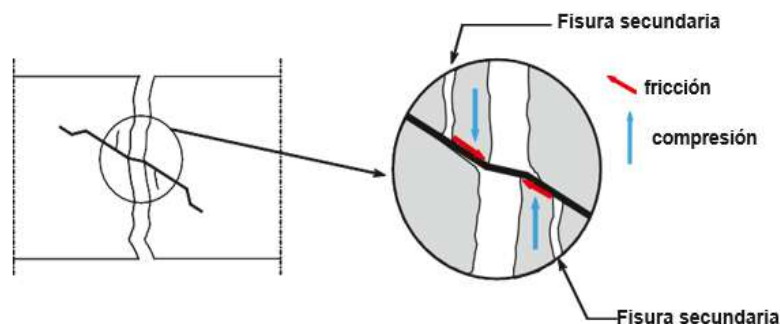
Agrietamiento secundario en hormigón reforzado con fibra de acero
